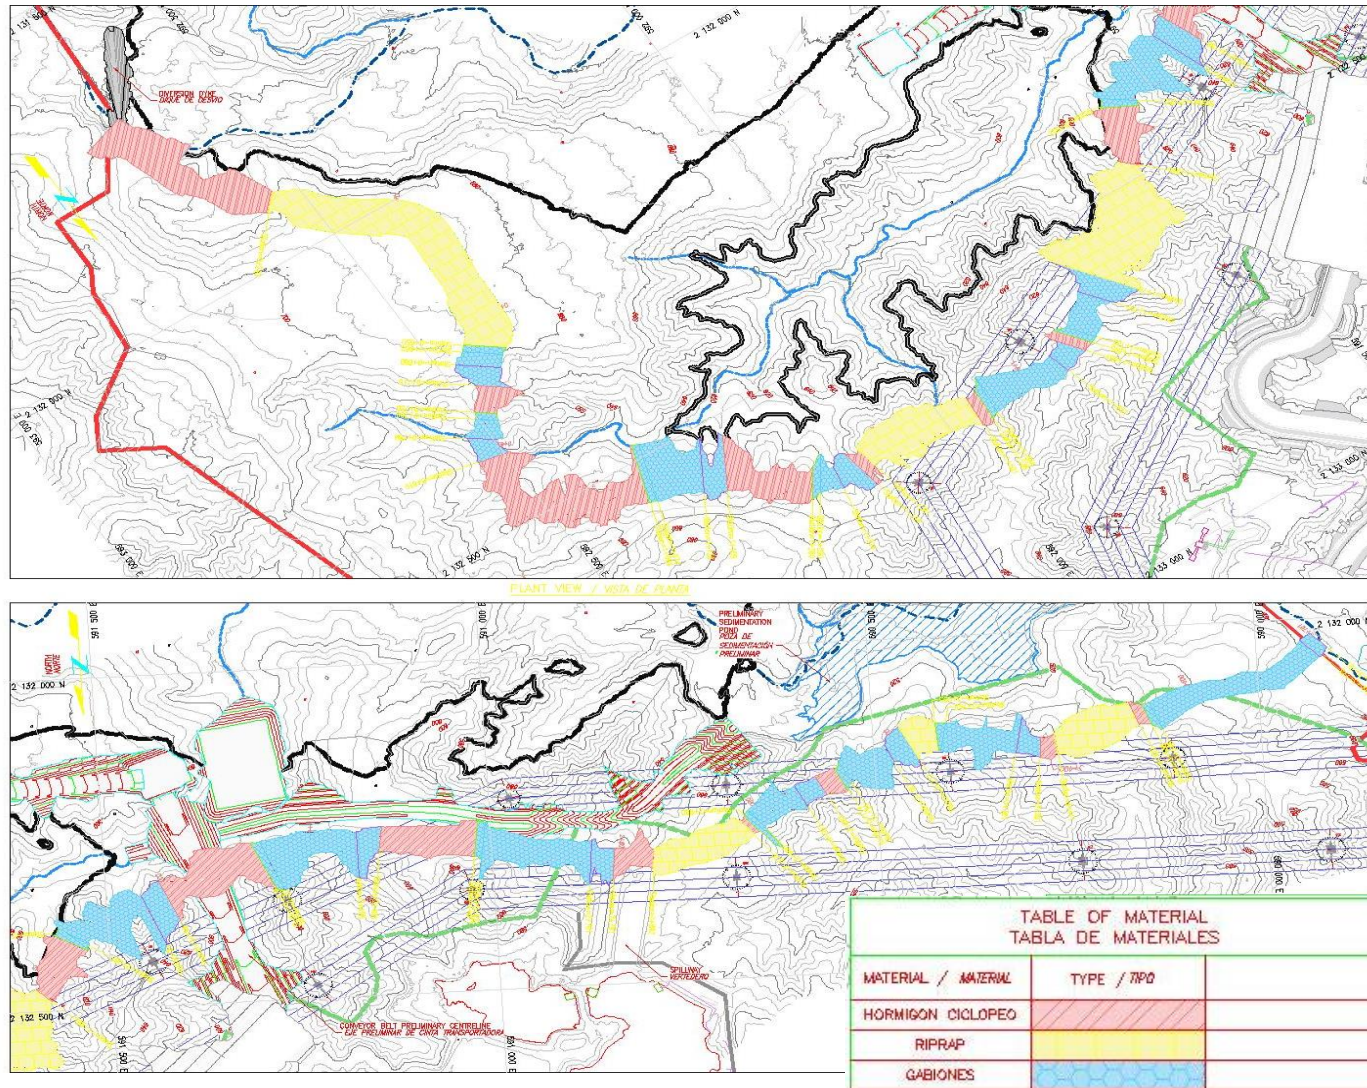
Vista en planta tipo de revestimiento para el canal de desvío.
